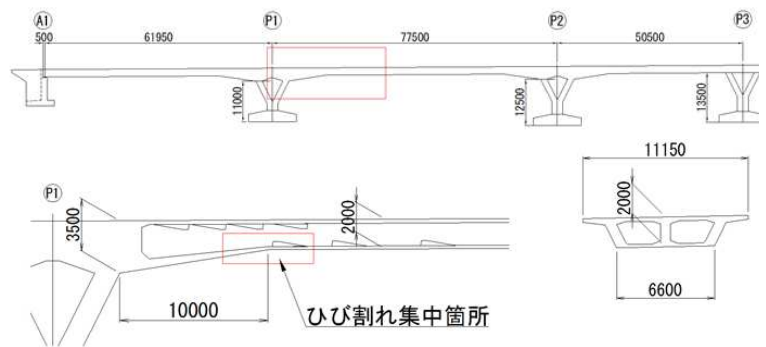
橋梁一般図 および ひび割れ集中箇所
